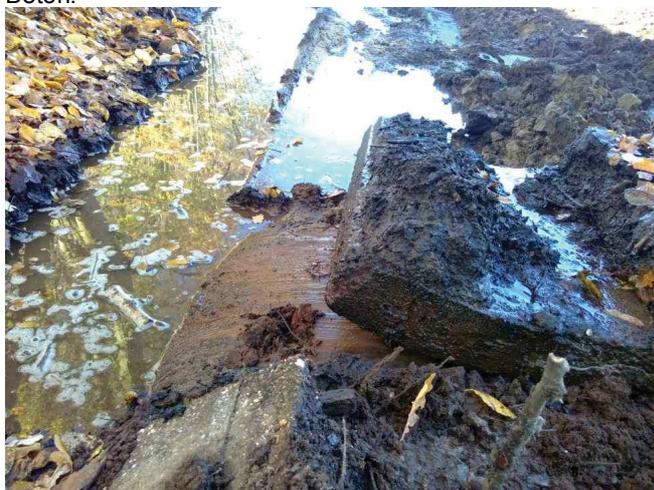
(15.11.18): Rückbau der Betonplatten des Bachgerinnes inklusive der Kieselrotschüttung unter dem Beton.
